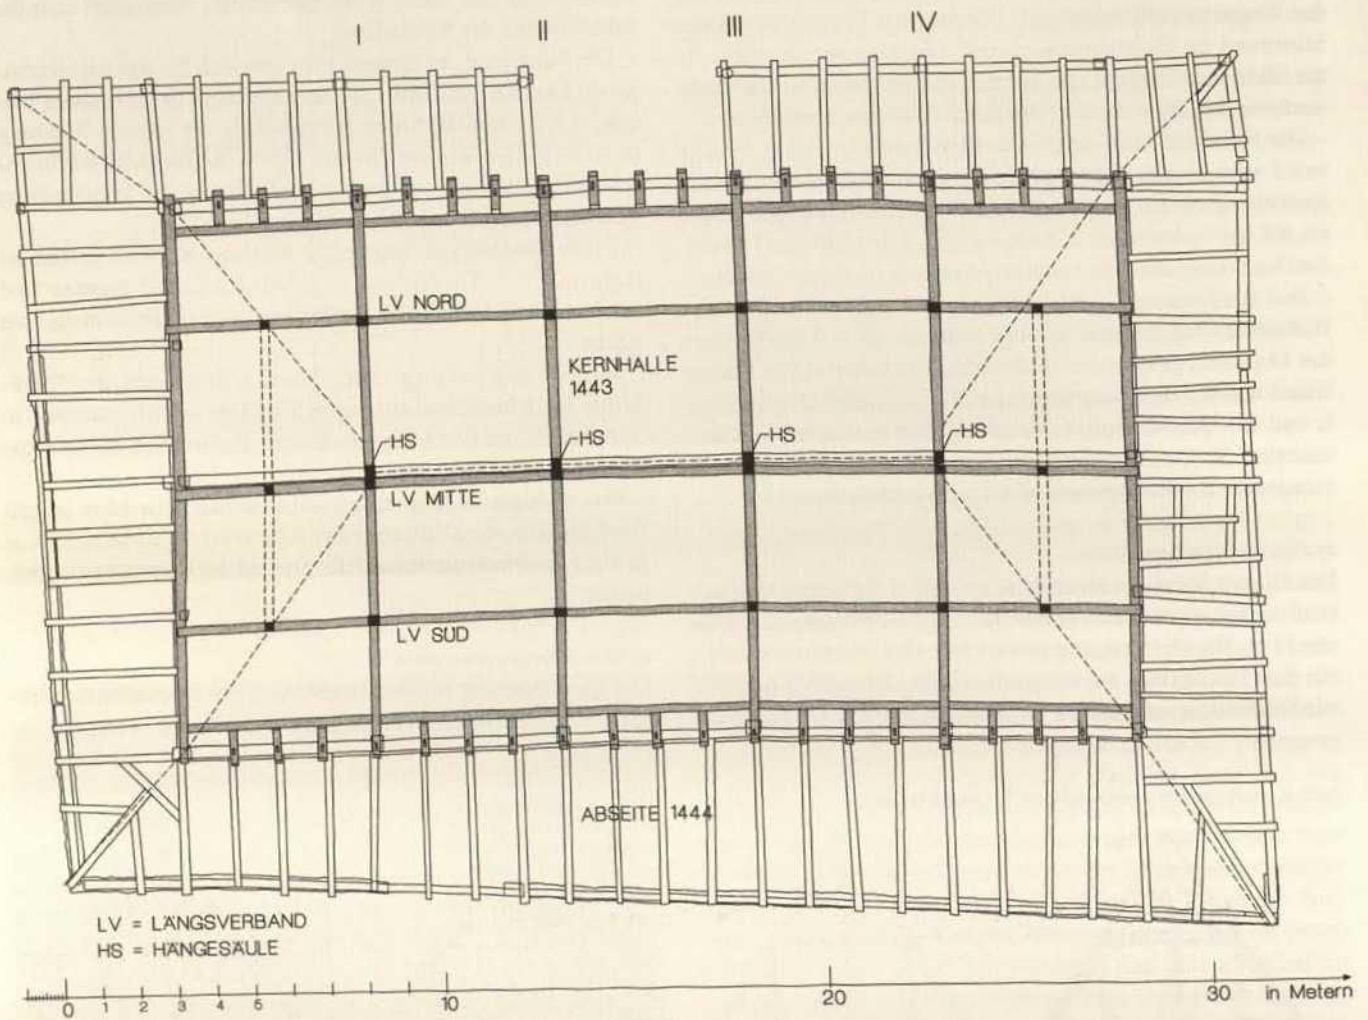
Grundriß mit Balkenlagen über der Kernhalle und den Abseiten.
